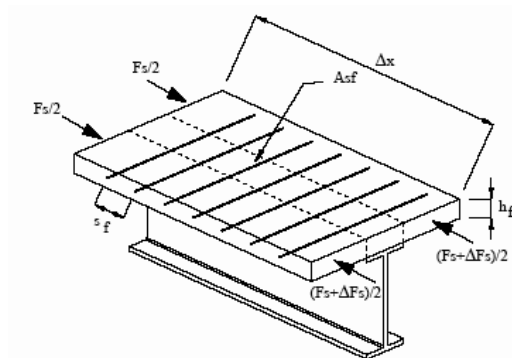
Distribuzione della sollecitazione di taglio longitudinale nella piattabanda di calcestruzzo
